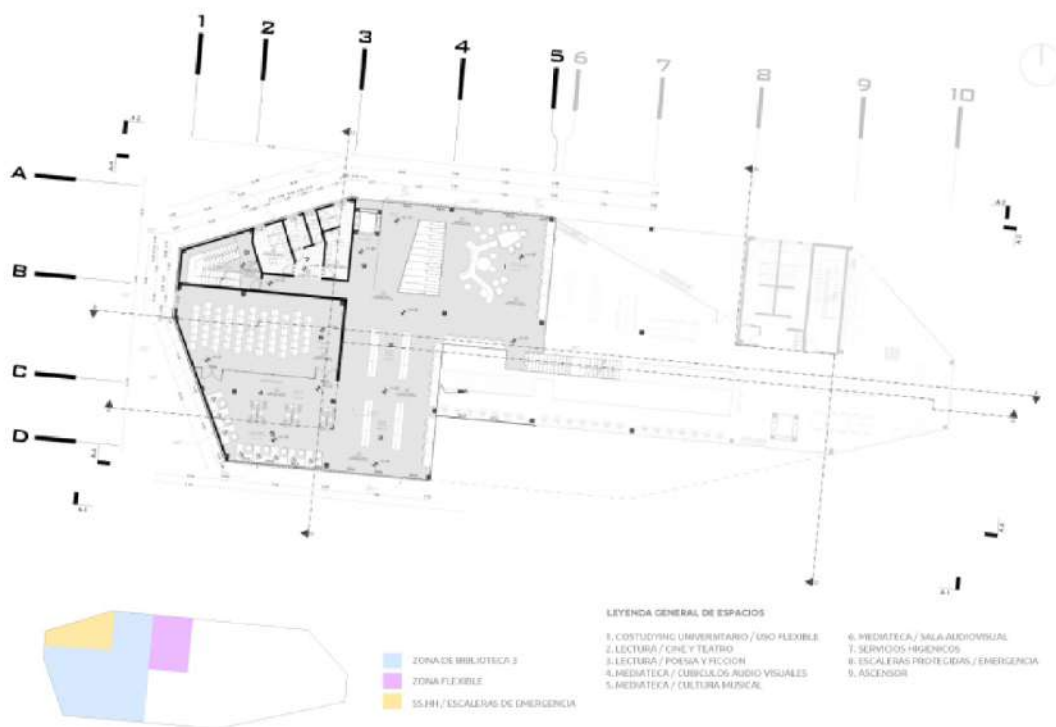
Plano de Cuarta Planta del bloque de biblioteca
